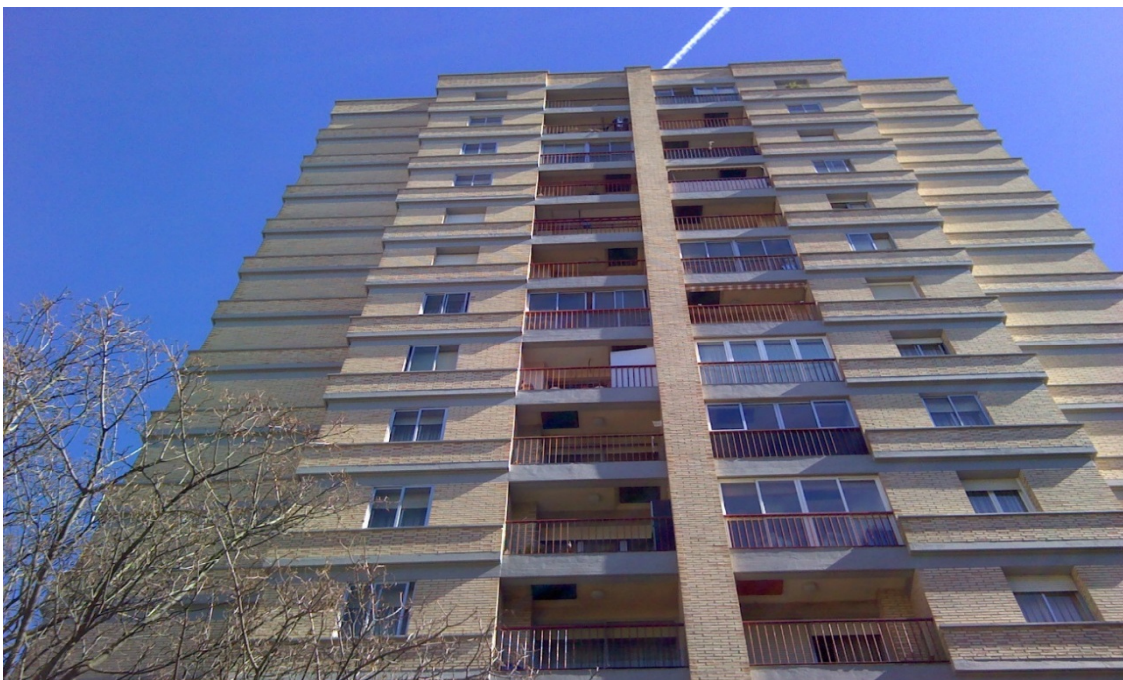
Estado actual. Fachada oeste: terrazas y miradores.
